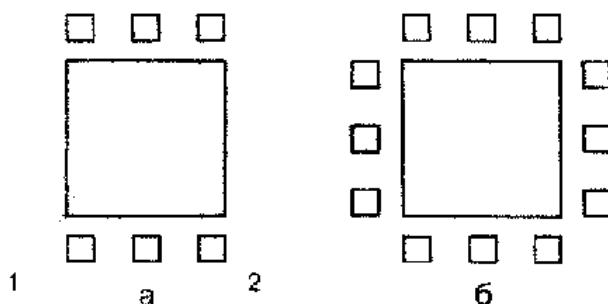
Схеми розташування виносних палей при підсиленні стовпчастих фундаментів: а – розташування палей з двох сторін; б – те ж по периметру; 1 – фундамент, що підсилюється; 2 – палі
